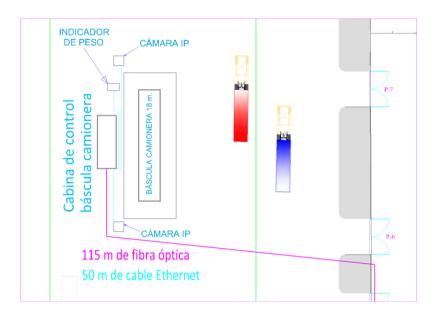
Plano de cableado estructurado para cámaras e indicador de peso
